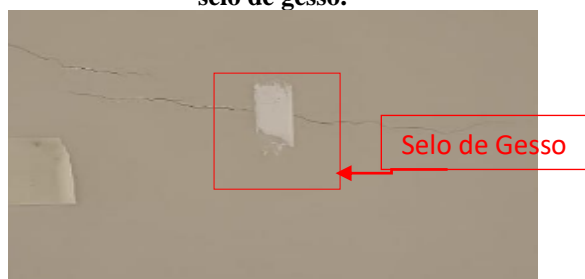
Fissura de ID 16 na alvenaria de vedação, na parte Interna
